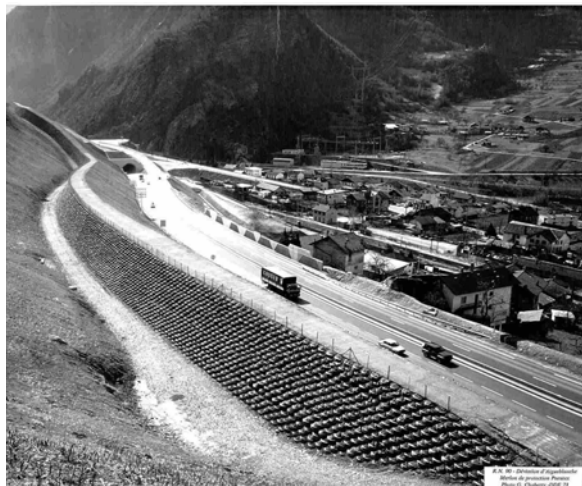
Construction d'un merlon avec un parement en Pneutex: protection de la RN 90 à Aigueblanche, Savoie (photo Cete Lyon). [Cliquer pour agrandir](#)
